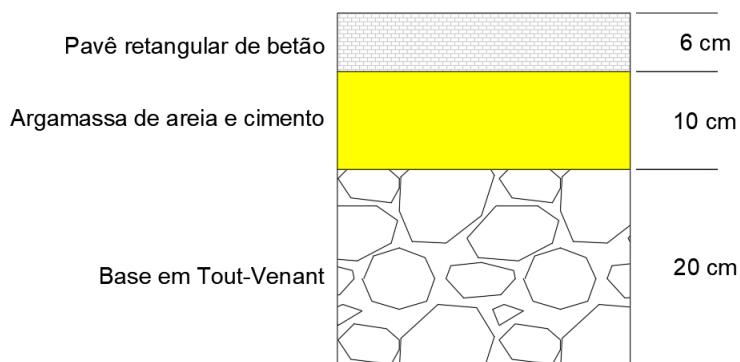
Esquema para a Estratificação da Rede pedonal. Adaptado de (CMB, 2011)
